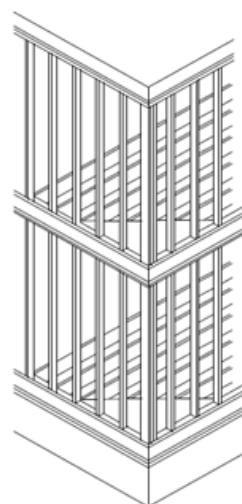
Detalhe em alto padrão na construção em “*Wood Frame*” no Canadá.
